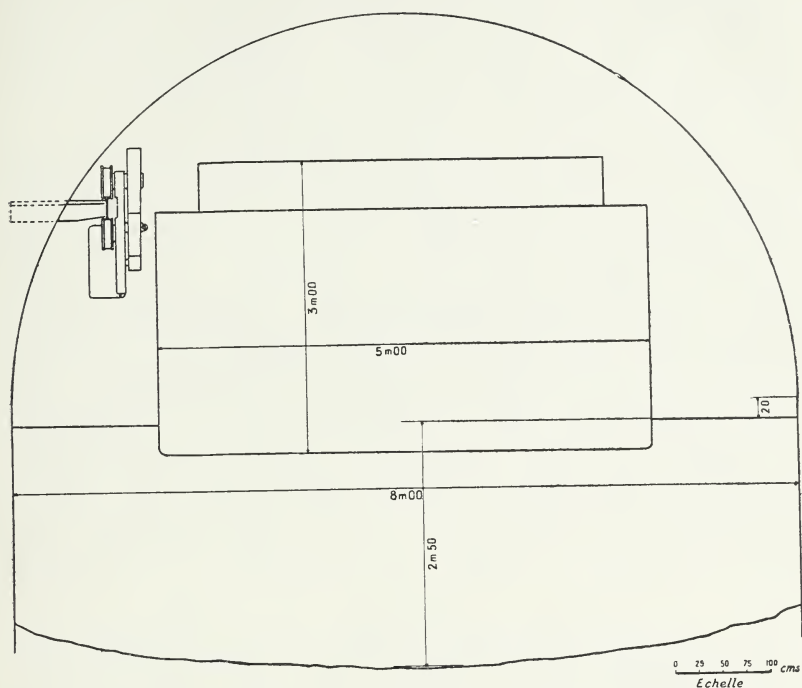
Dispositif de la voie et du tracteur à adhérence proportionnelle en tunnel.
